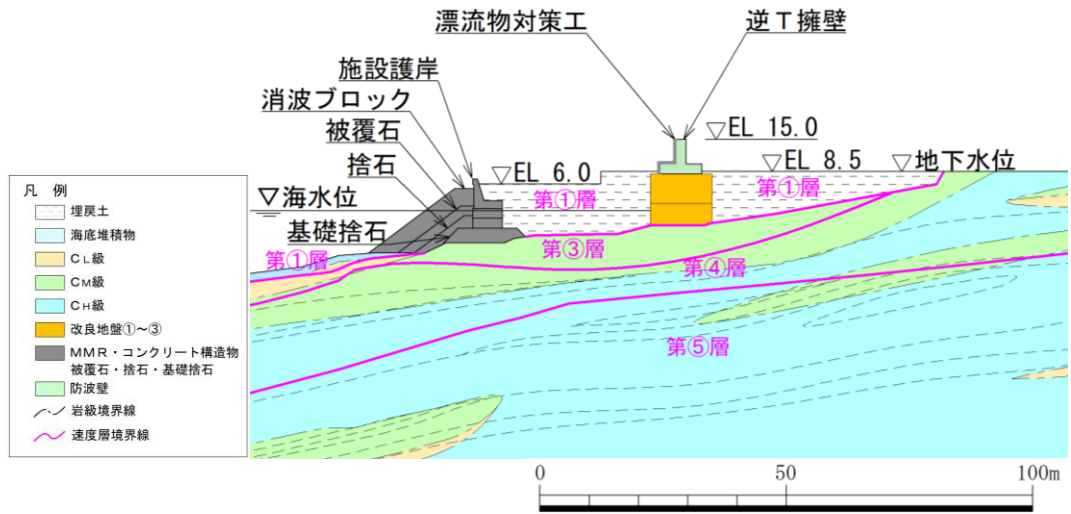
防波壁（逆 T 擁壁）の横断面図（①-①断面）
